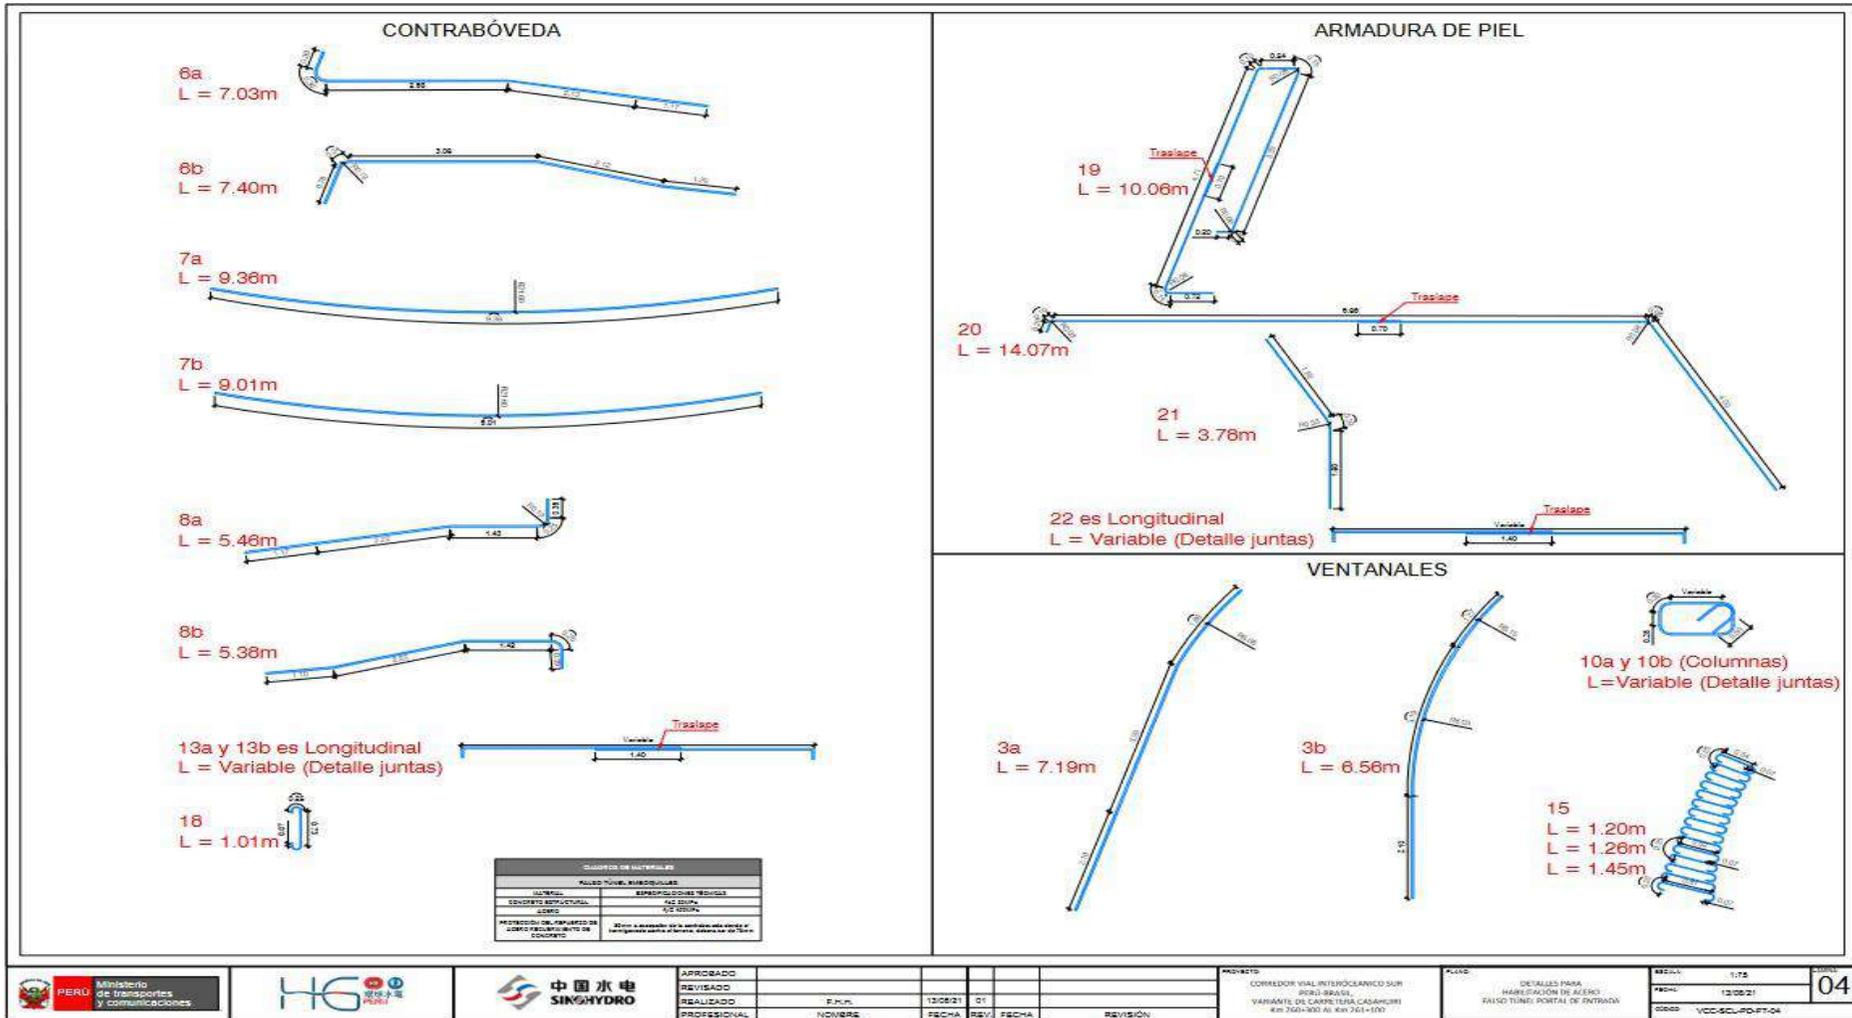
Dimensiones de las piezas de acero (contra bóveda, armadura de piel y ventanales)
